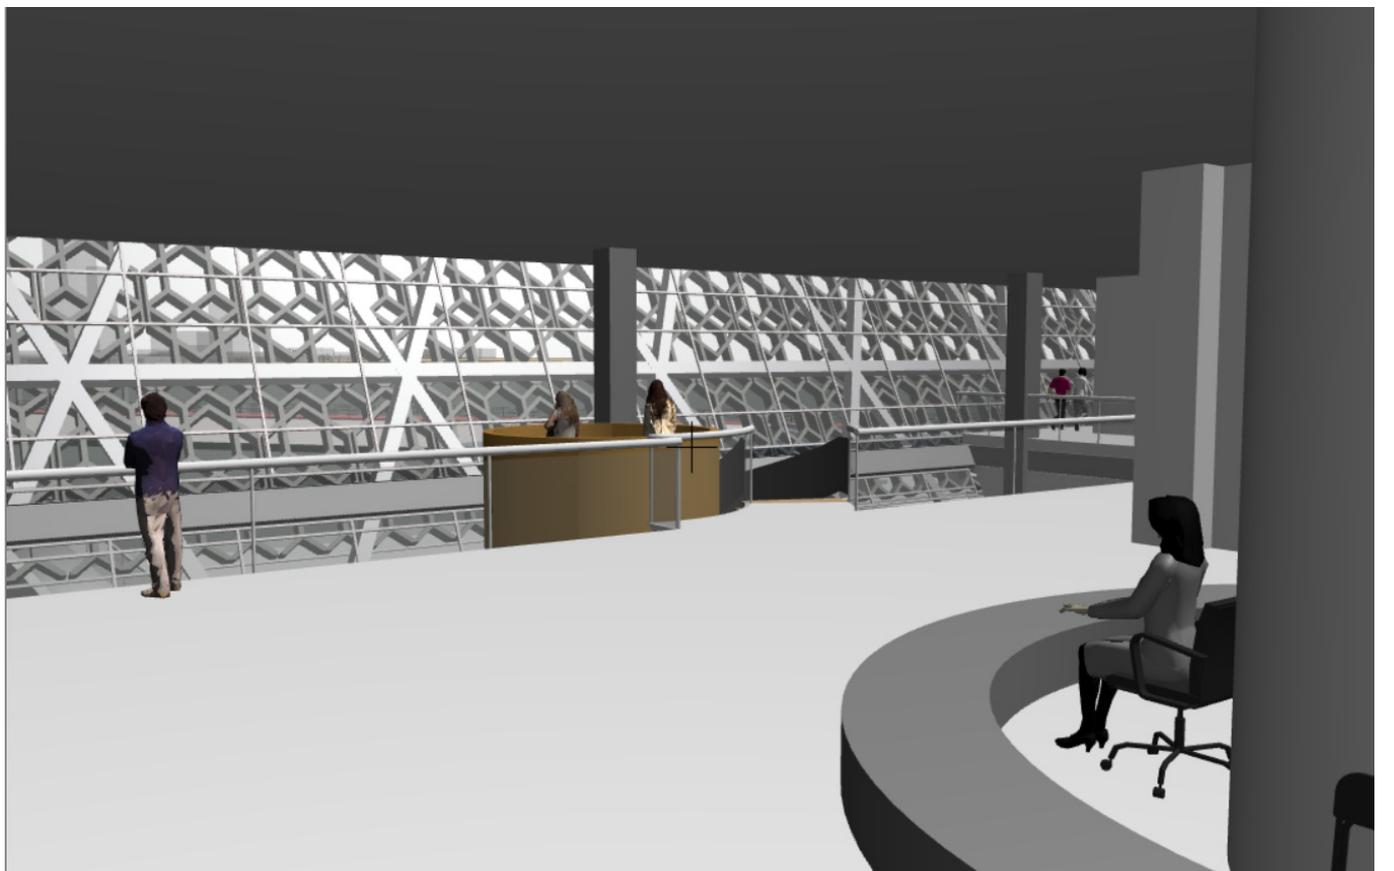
Imagem recepção principal - Primeiro Pavimento. Fonte: Produzida pela autora.
